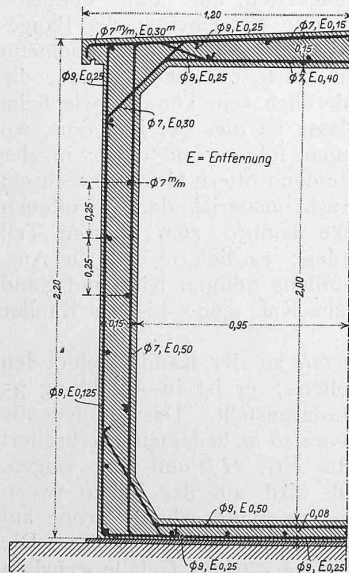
Schnitt durch den untersten Teil des armierten Betonkanals. — 1 : 30.
